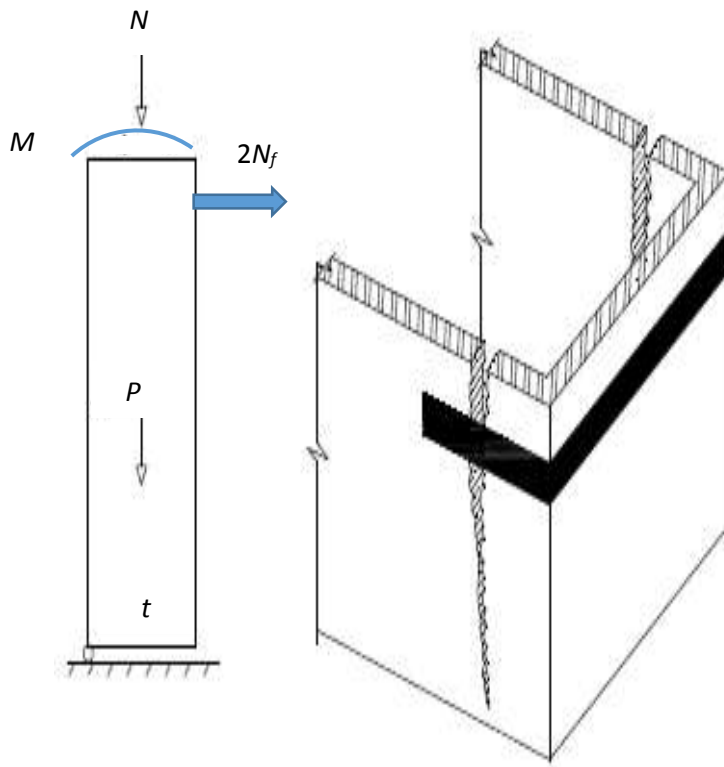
Схема усиления кладки стены с трещинами от опрокидывания
